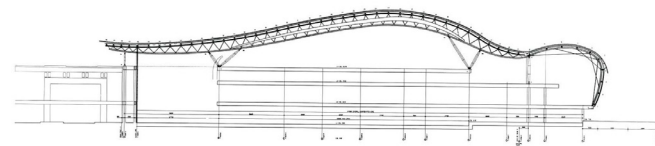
Aeropuerto Internacional de Cibao | Fuente: Renzo Piano Building Workshop (2023)
